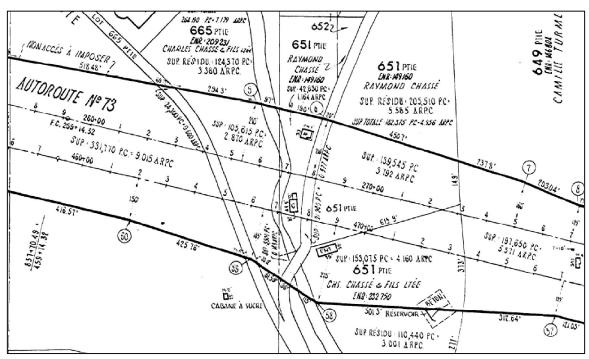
Projet n° 154-09-0389, site CcEs-d, plan d'expropriation en vue de la construction de l'autoroute 73, en 1975 (source : ministère des Transports du Québec, plan n° EX-75-553-449-2)
